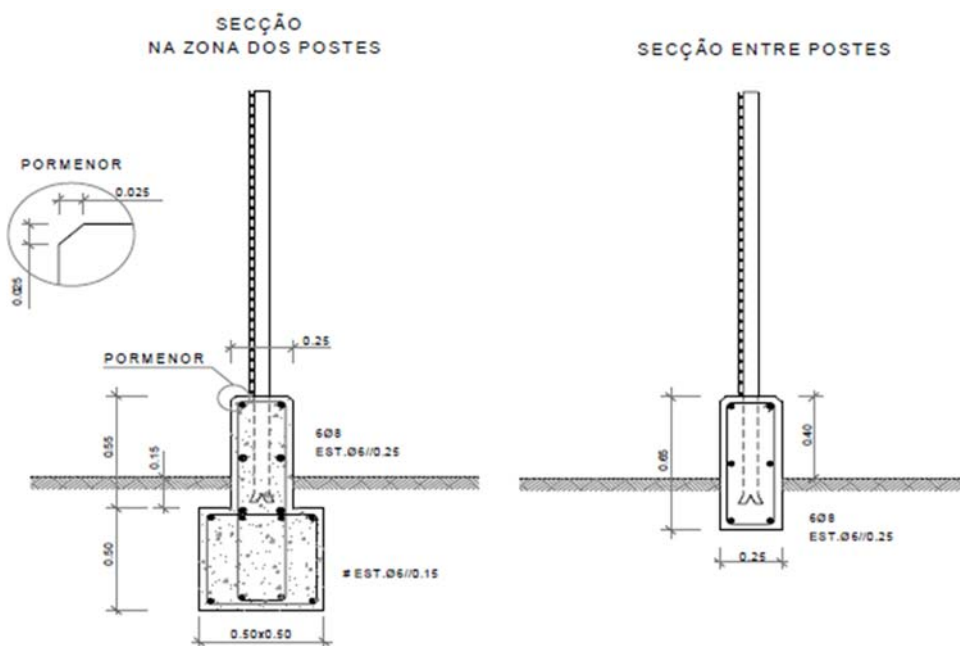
Geometria e pormenorização de armaduras do murete de apoio
